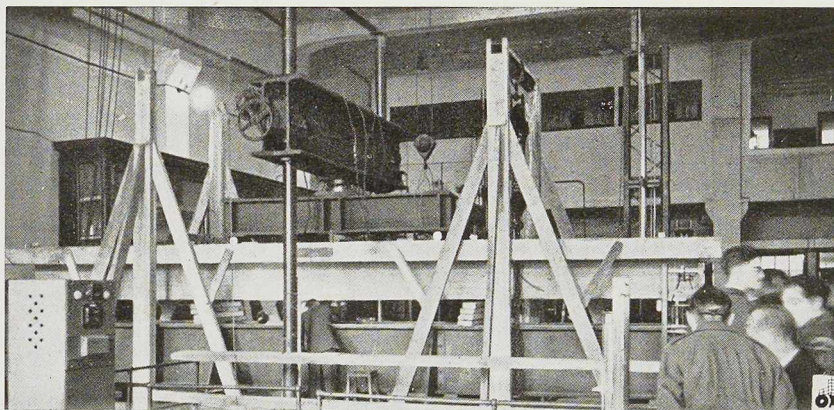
Bâti métallique réalisé pour les essais de laboratoire de la poutre enrobée.
